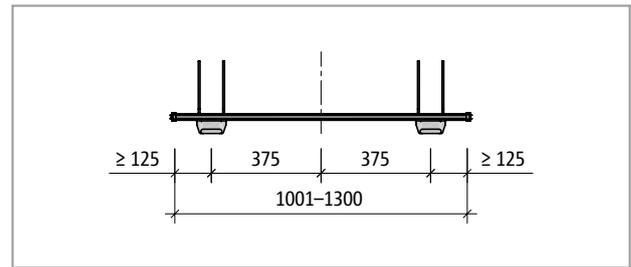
Schöck Tronsole® Typ T-V2-...-L1001 bis L1300: Produktgrundriss
